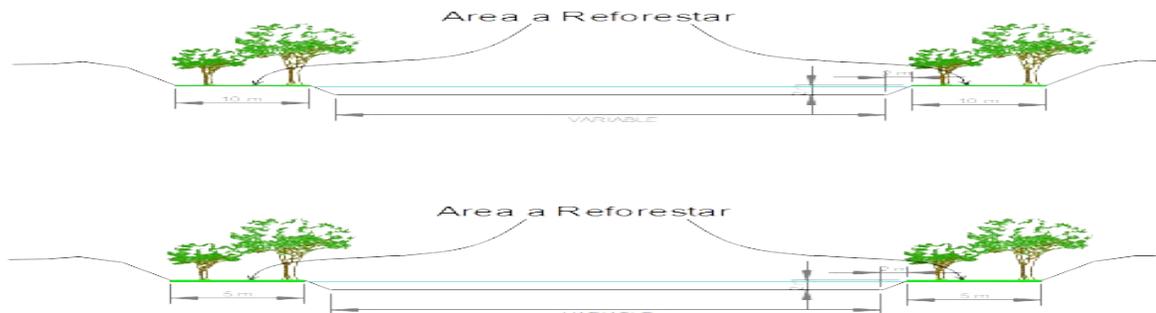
Sección tipo del cauce con el proyecto finalizado.
